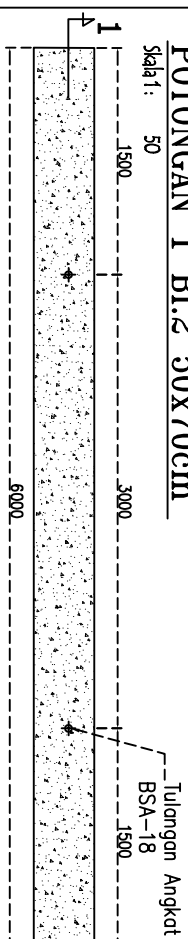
DETAIL TULANGAN ANGKAT BALOK BI.2 50x70cm
